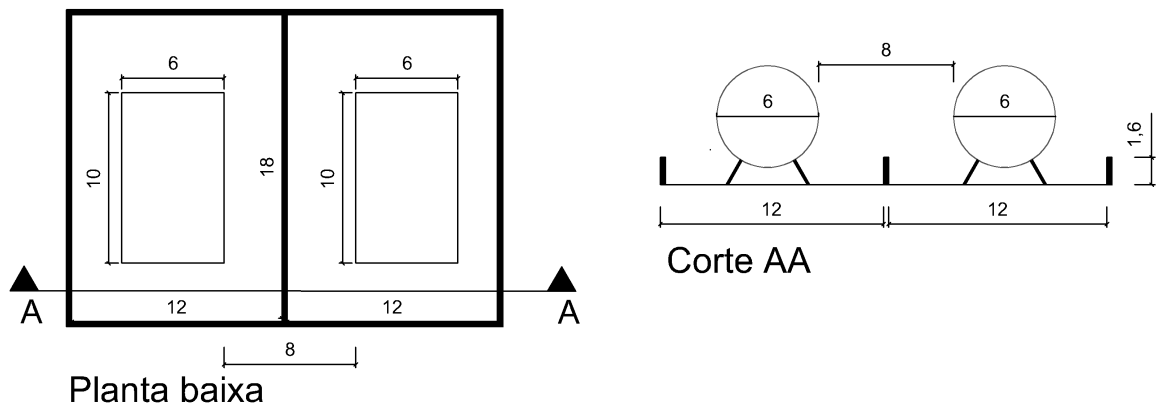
Planta baixa e corte referente a um parque de tanques horizontais.
